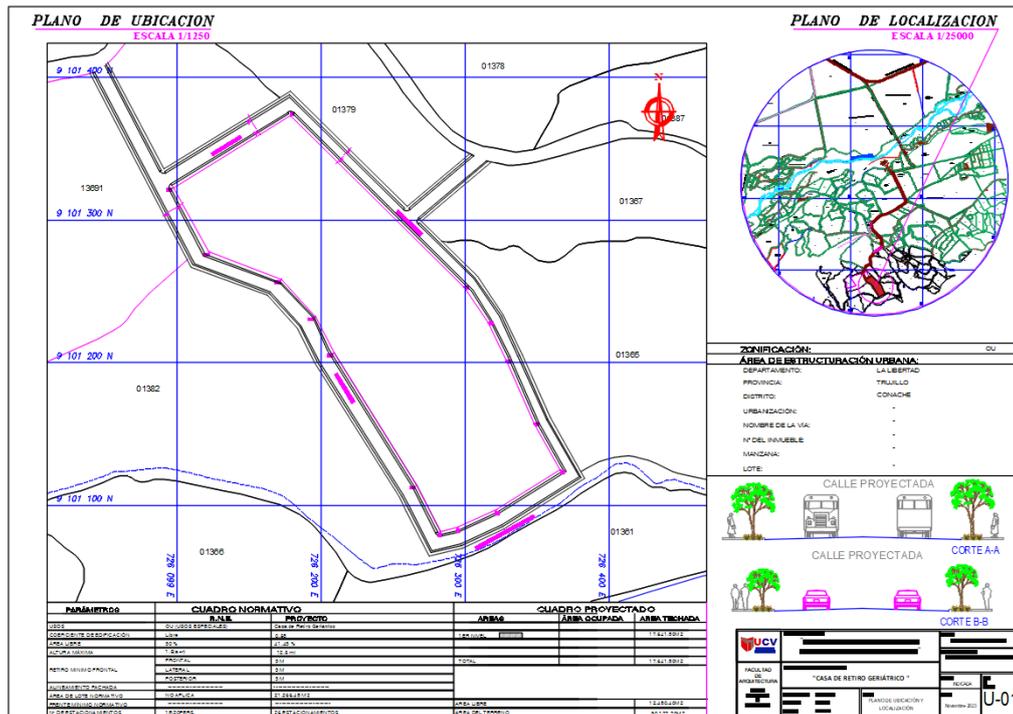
Plano de ubicación del terreno. Elaborado en base al plano de catastro de Trujillo.
